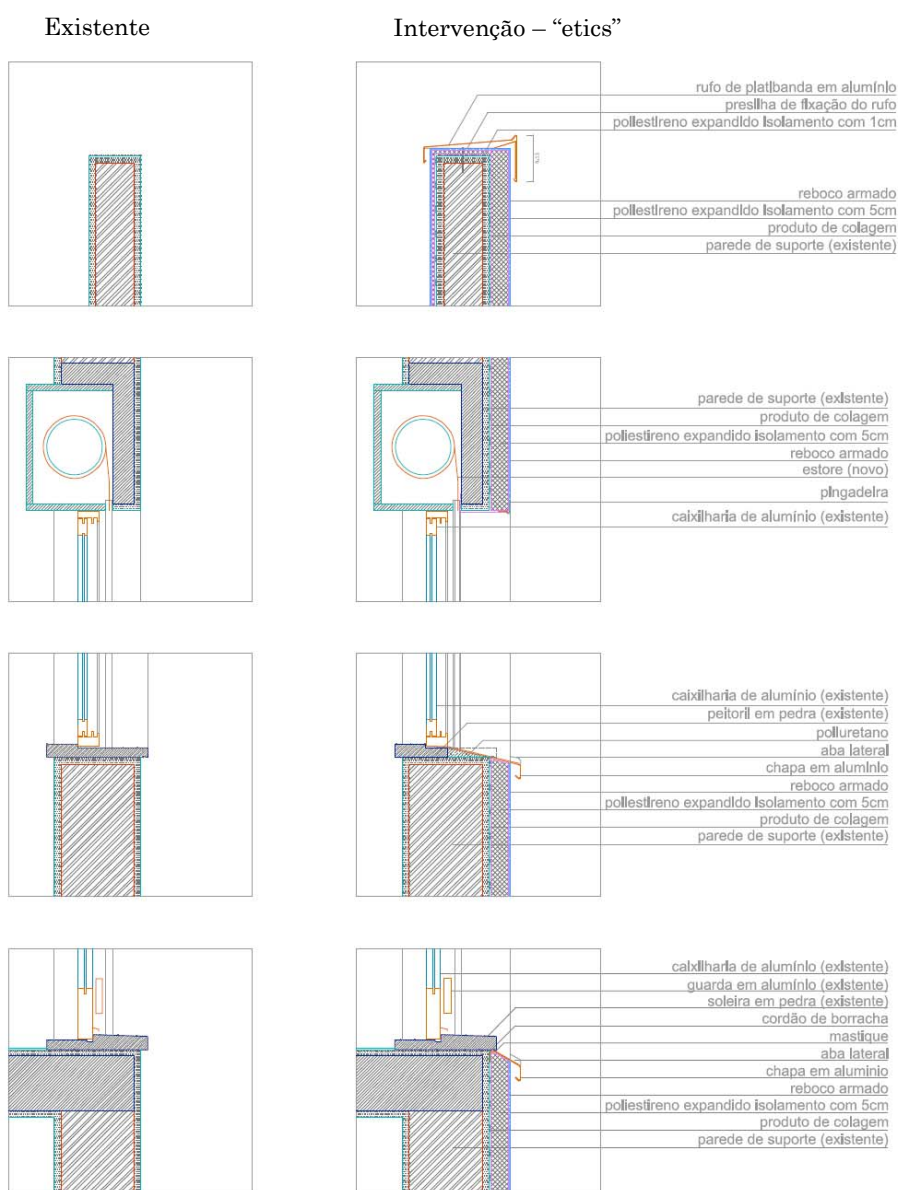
Corte construtivo vertical. Fachada corrente (escala 1/20).
